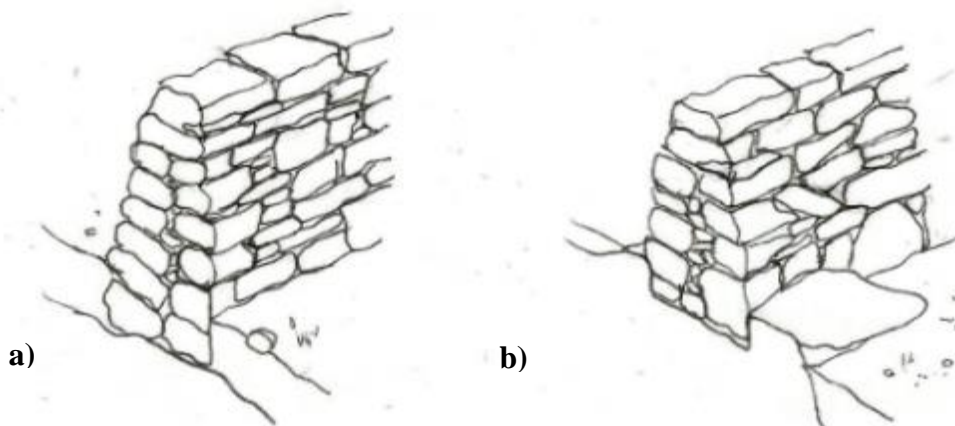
Muros de pedra seca: a) Fundação em solo; b) Fundação em sulco esculpido em afloramento rochoso
